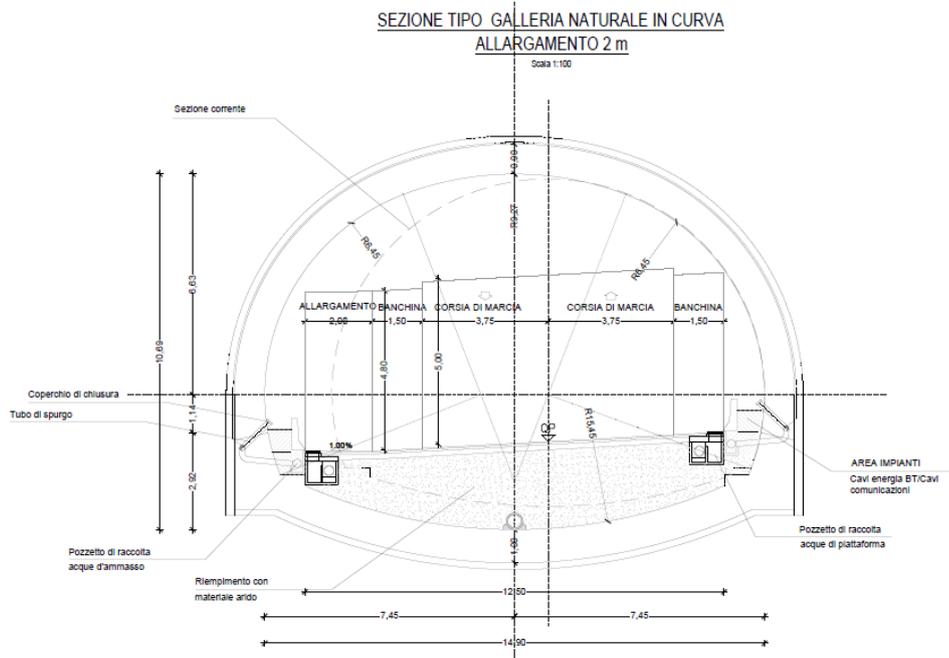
Galleria naturale, sezione tipo allargata 2 m.
